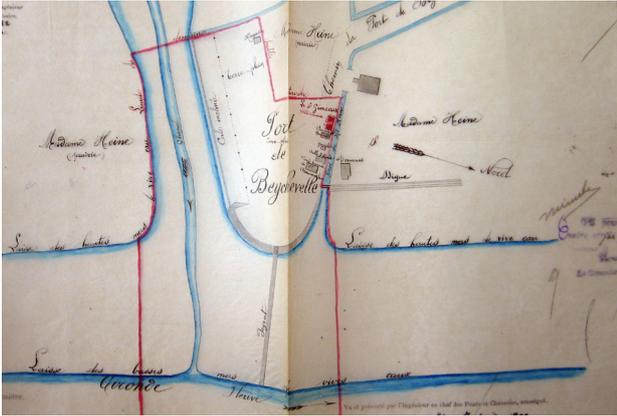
Plan du port de Beychevelle, installation d'un pont à bascule, 13 juin 1900. © Arch. dép. Gironde, SP 1180.
